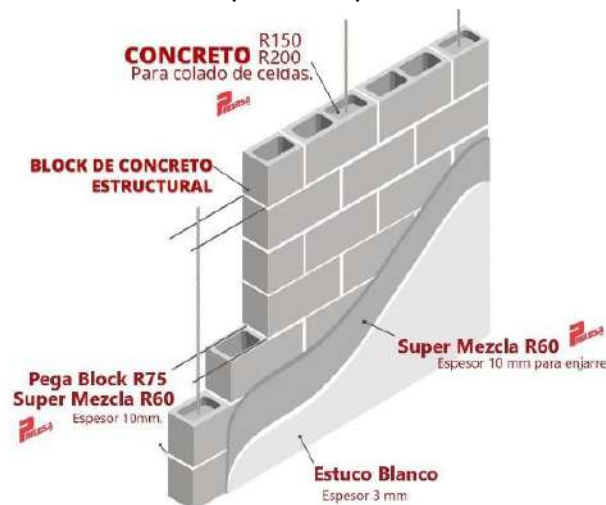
Muro de concreto. Fuente: (Perlosa,2021)
